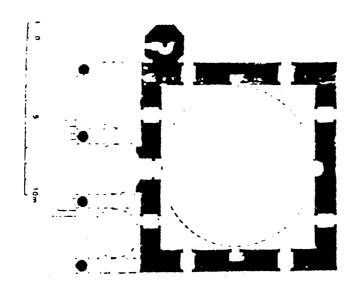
مسقط أفقي لمسجد صرجالي بقونية (عن: Aslanapa).
